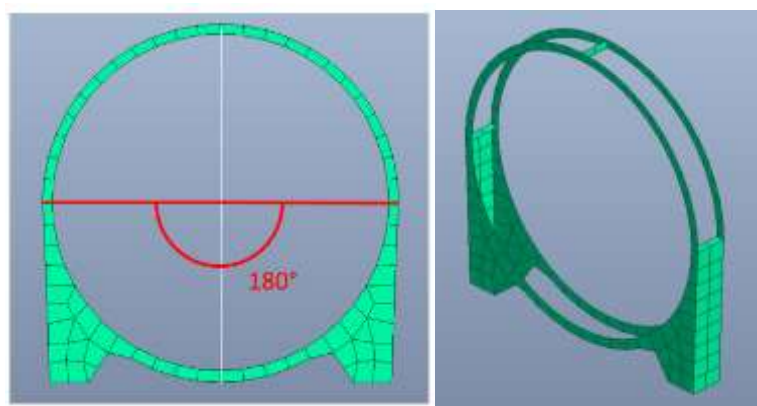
Elementi di irrigidimento – Sp 30 mm | Interasse 9 m
